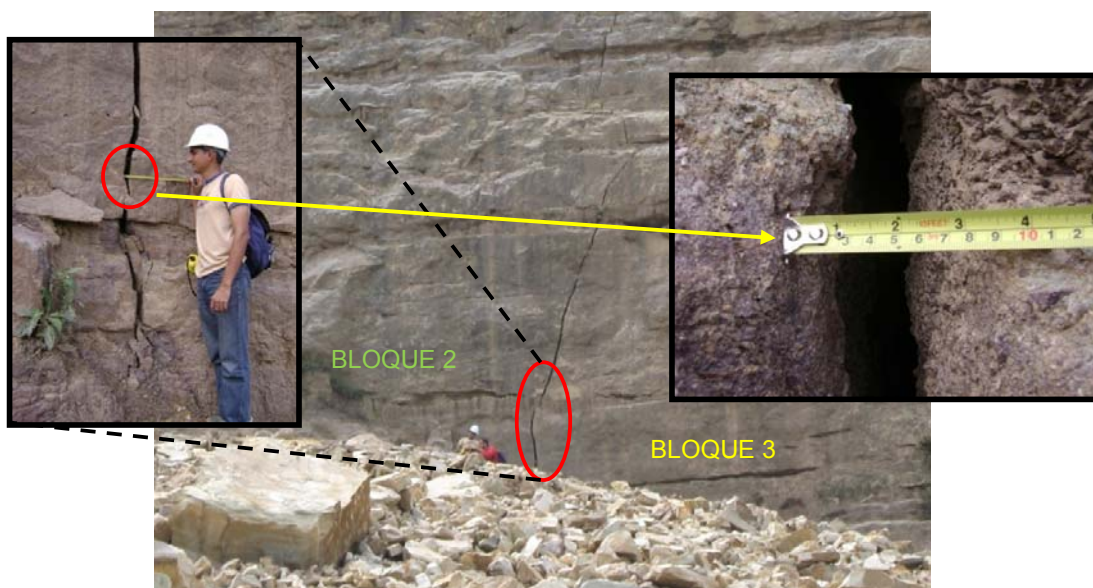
Fisura A, entre los bloques 2 y 3.
